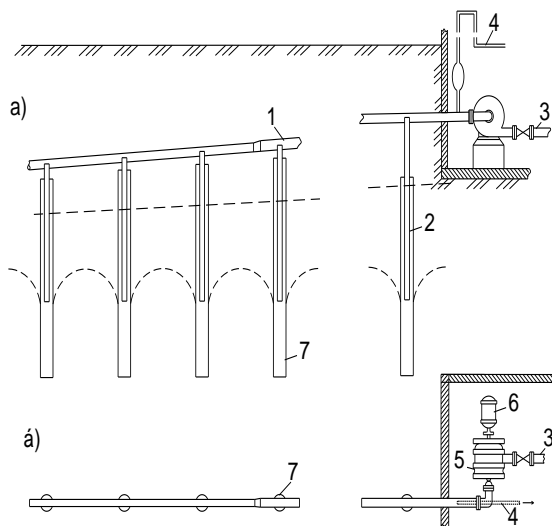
Схема вакуумного вертикального дренажа с всасывающим трубопроводом
